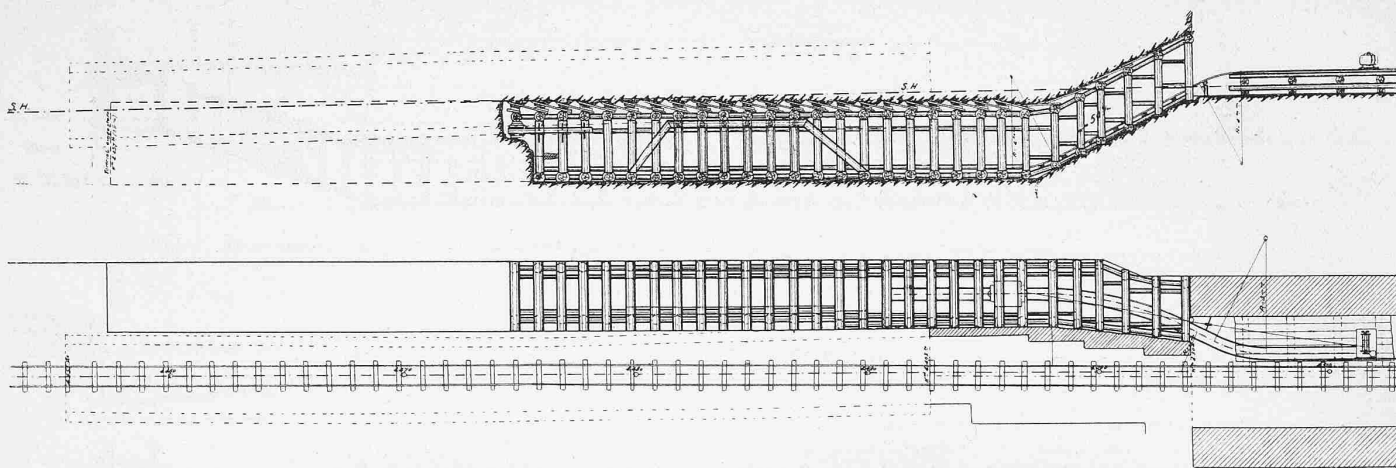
und 15. Grundriss und Längsschnitt durch Unterstollen links (westlich); Ausbruch und Zimmerung. — Masstab 1:300.
